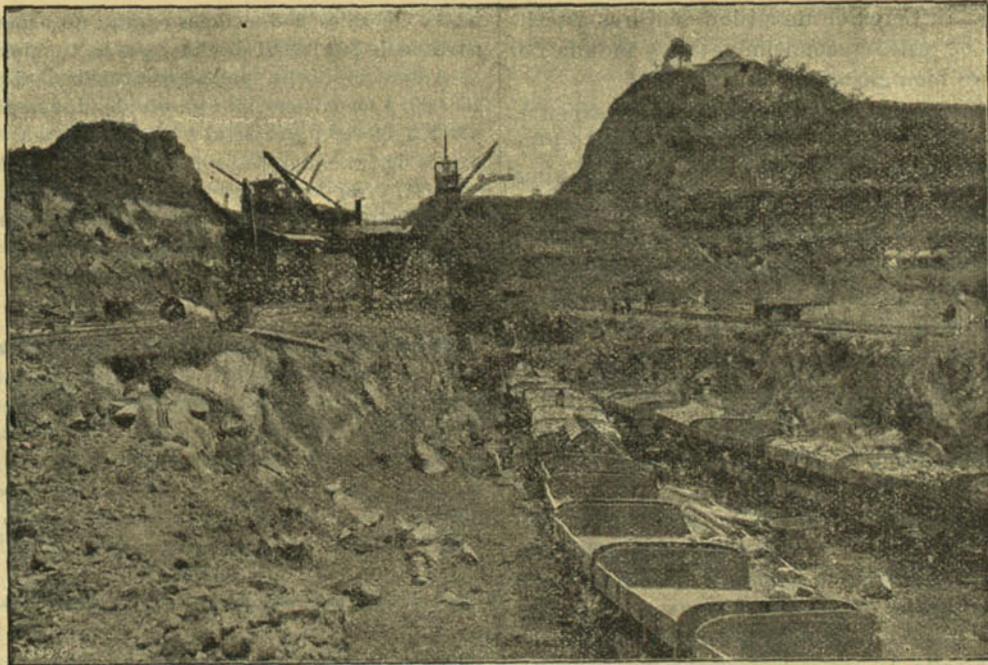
<sup>a</sup>—LAS OBRAS EN EL CORTE DE LA DIVISORIA.
